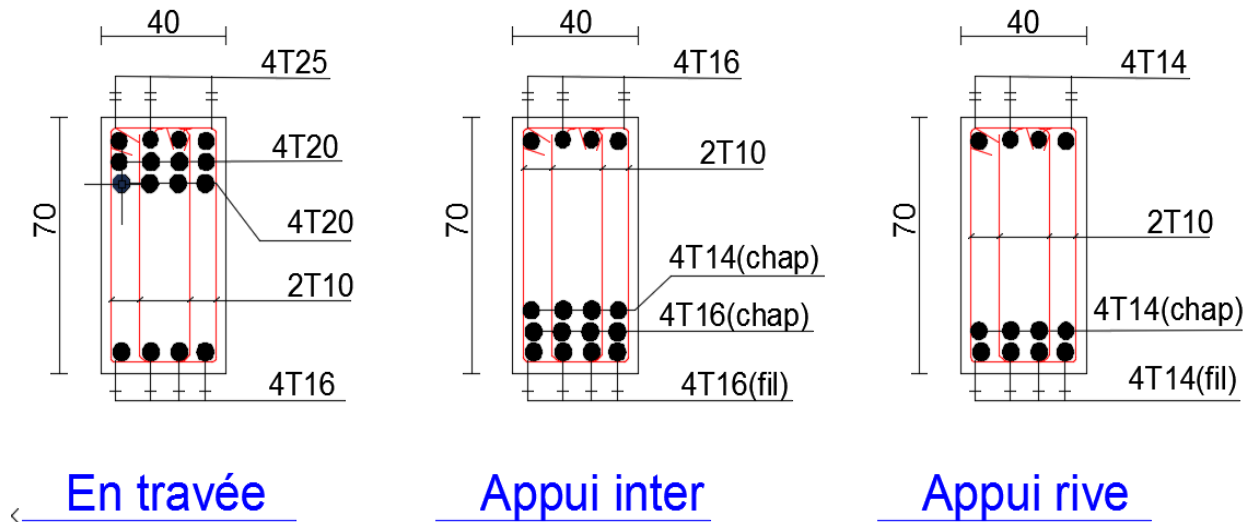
Ferrailage de la poutre de libage suivant le sens longitudinal.
